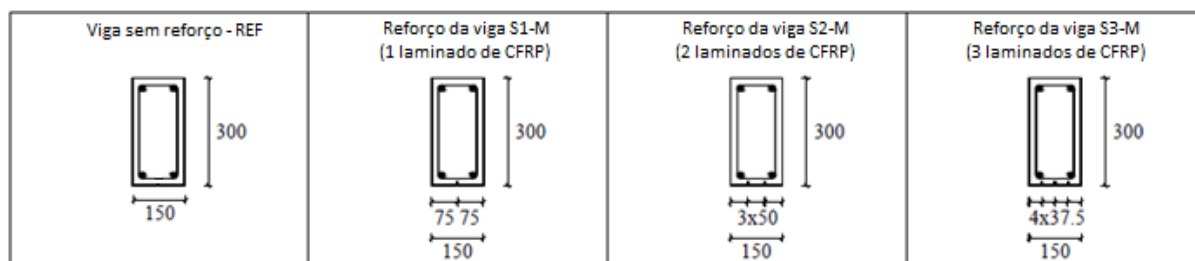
Secções transversais das vigas ensaiadas (adaptado de Dias *et al.*, 2012).
